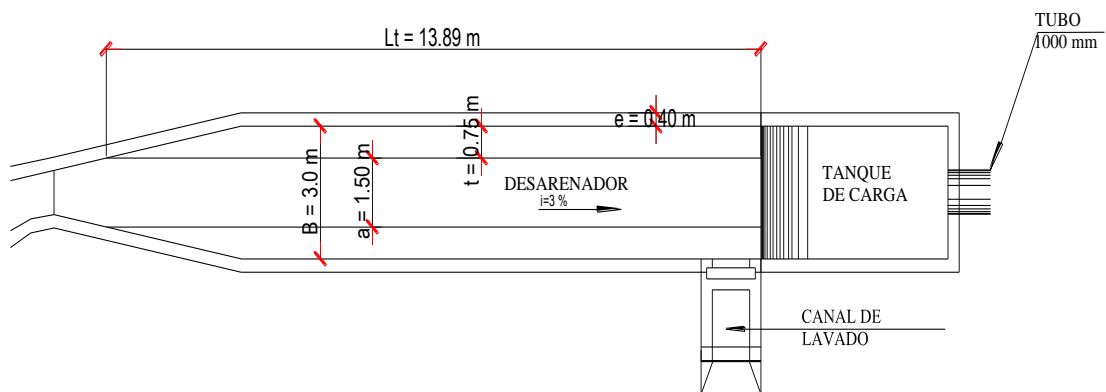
Desarenador vista en planta (Elaborado por Herrera Diego)
